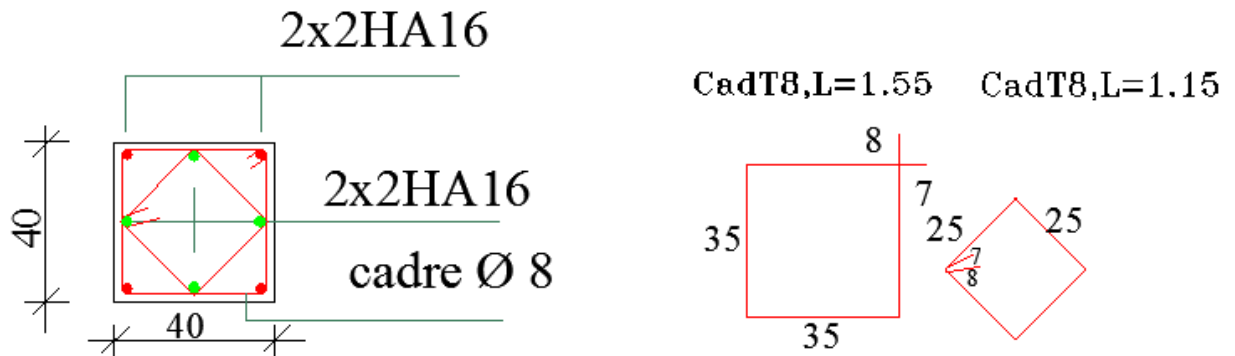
Disposition des armatures dans les poteaux (40x40)
